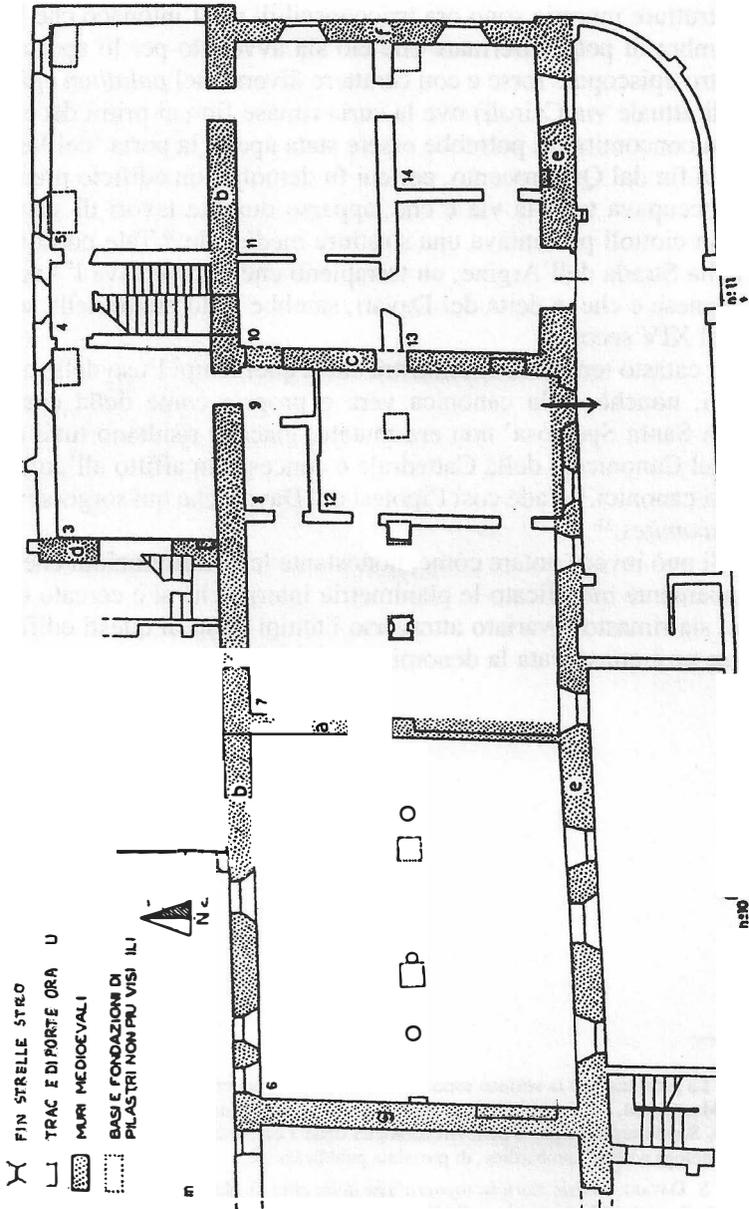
Piazza Canonica di San Pietro, nn. 10-11, planimetria del pianterreno.
